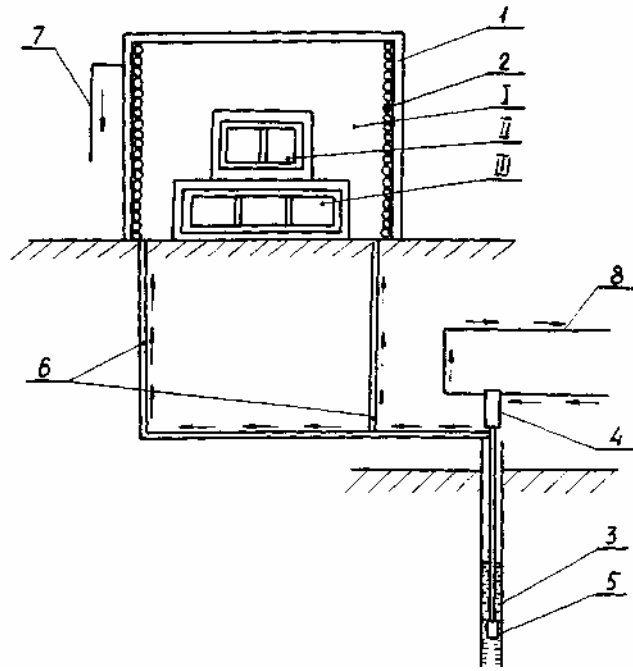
Схема теплохолодообеспечения отдельного здания,
